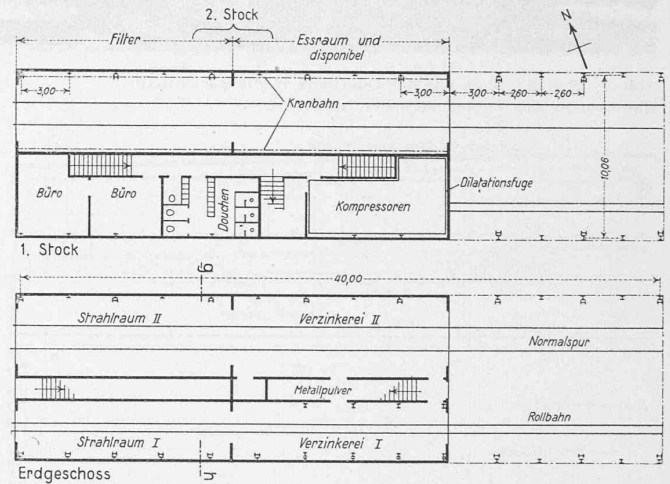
Metallspritzwerk. Grundrisse 1:400
